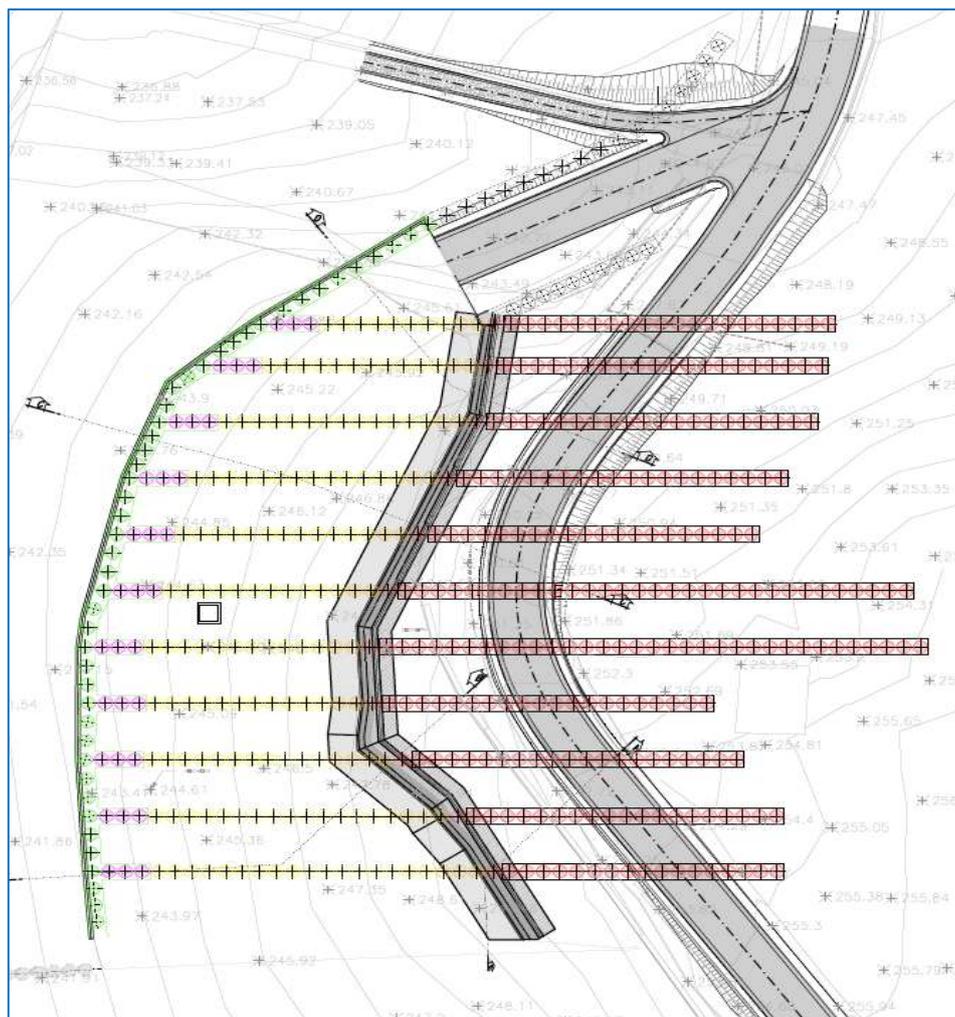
Planimetria di inquadramento intervento di mitigazione Piazzale RI57
